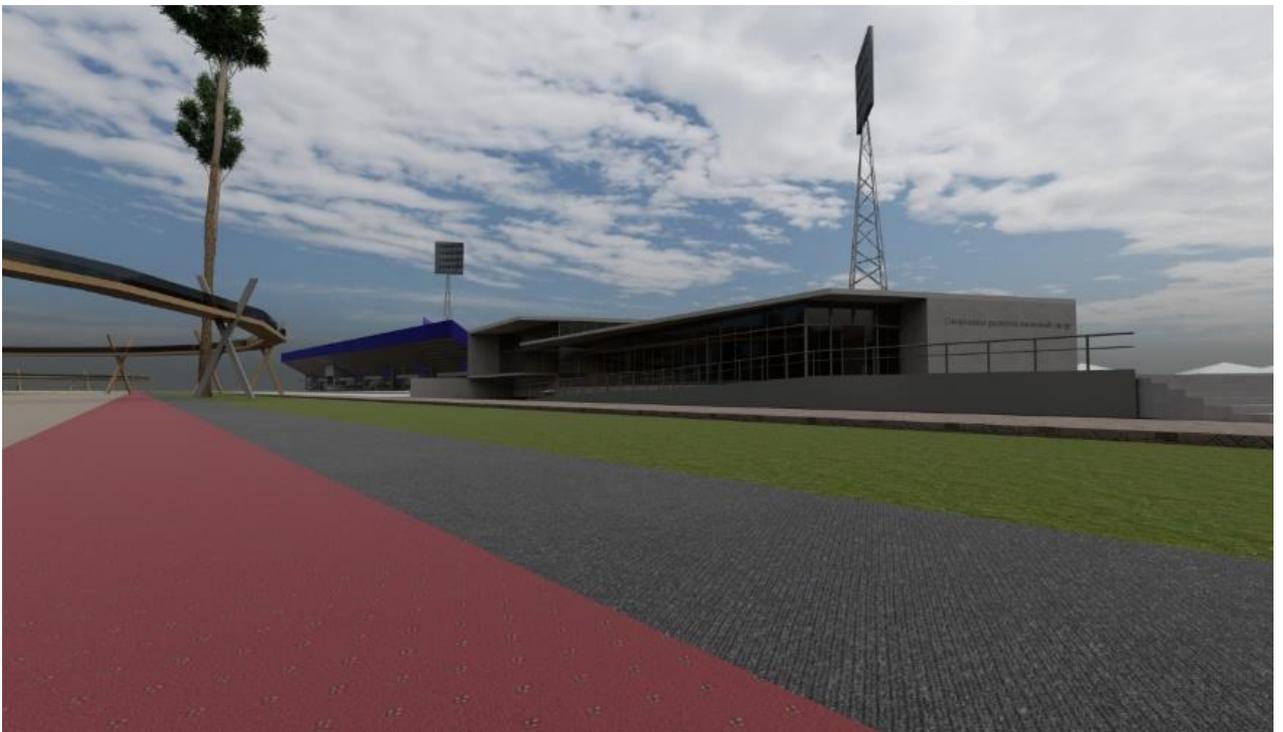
Вид на предполагаемый спортивно-развлекательный центр
